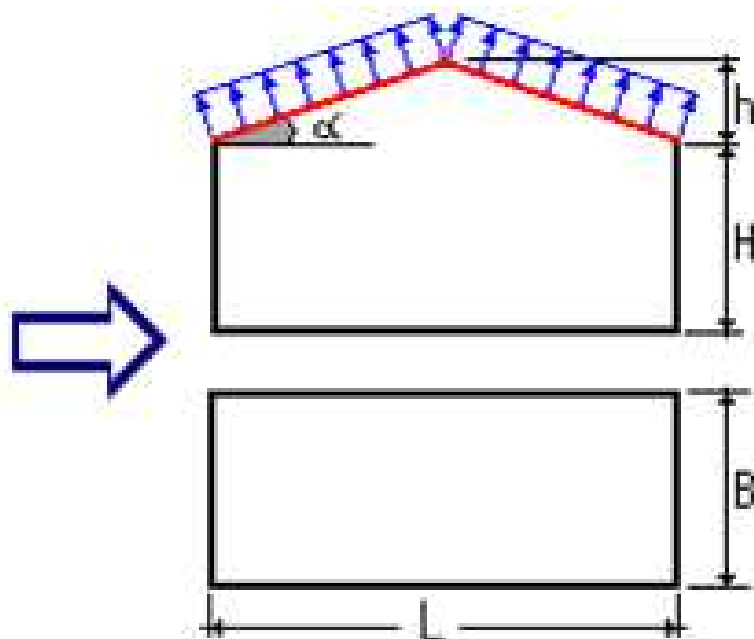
Схема приложения нагрузки на кровлю
